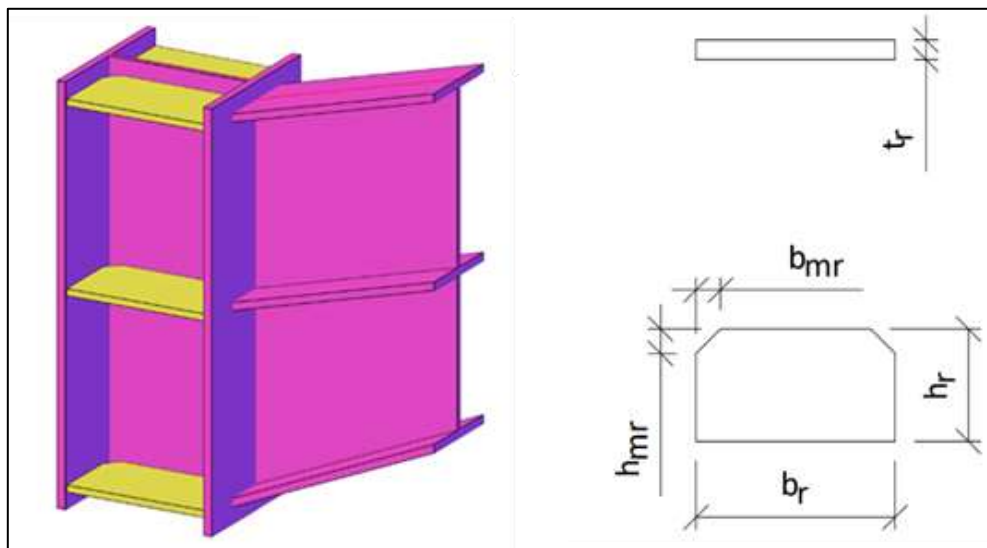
Conexión a momento Viga – Columna (Perfiles: alma llena)
